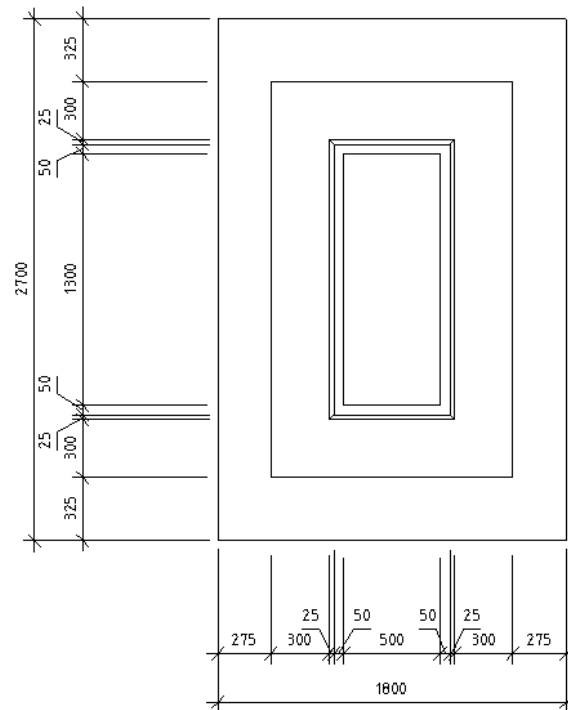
Конструювання фундаменту ФМ-1.
